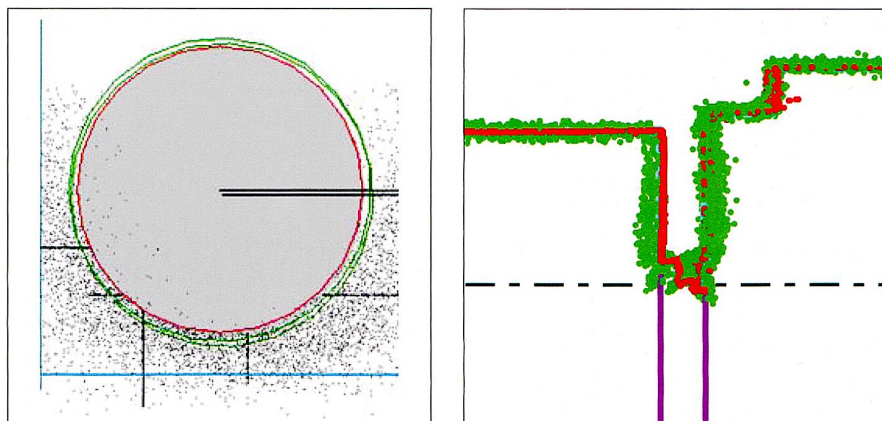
Sezione telai delle porte e sezione trasversale di una condotta.
